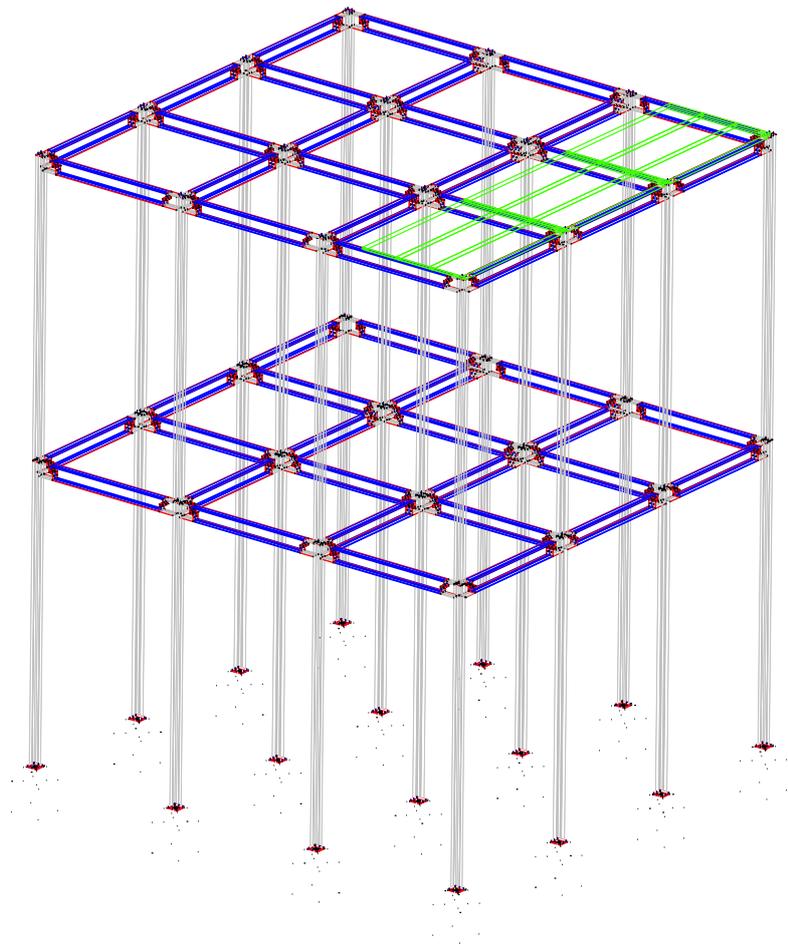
Perspective assemblage poteau ,poutre ,semelle et dalle.
